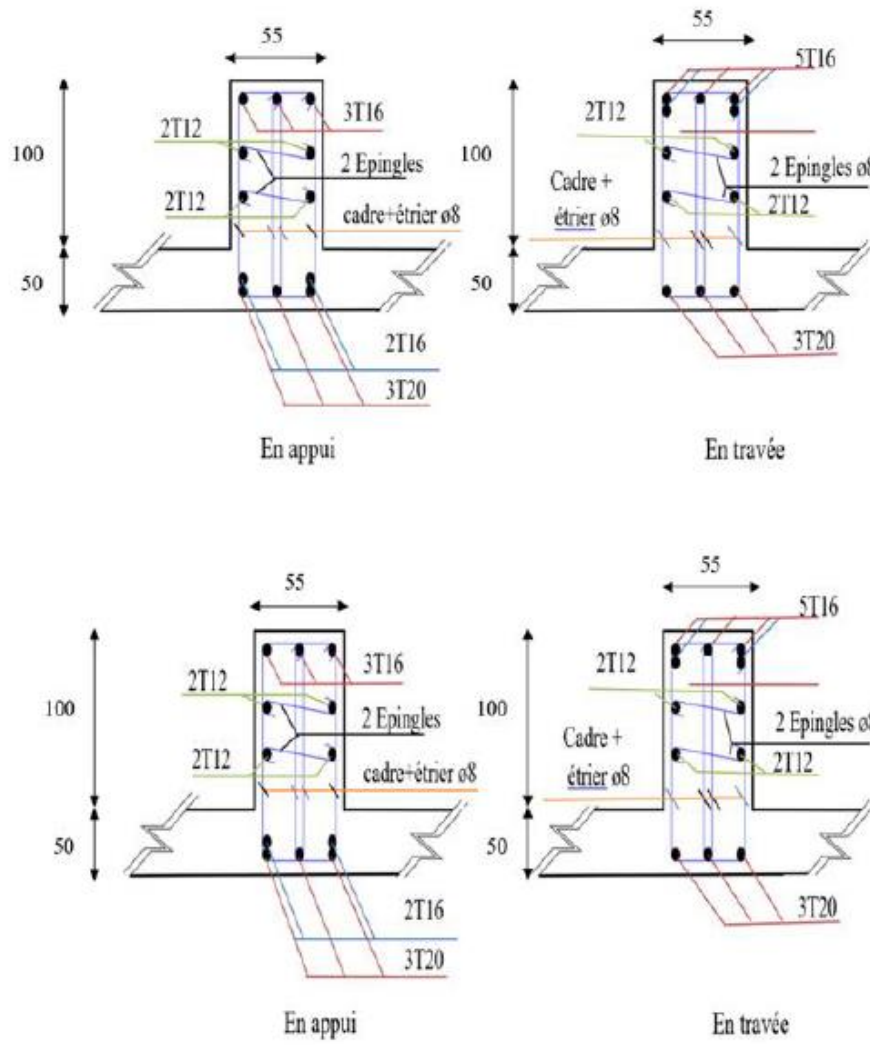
Ferrailage des poutres en travée et en appui.
